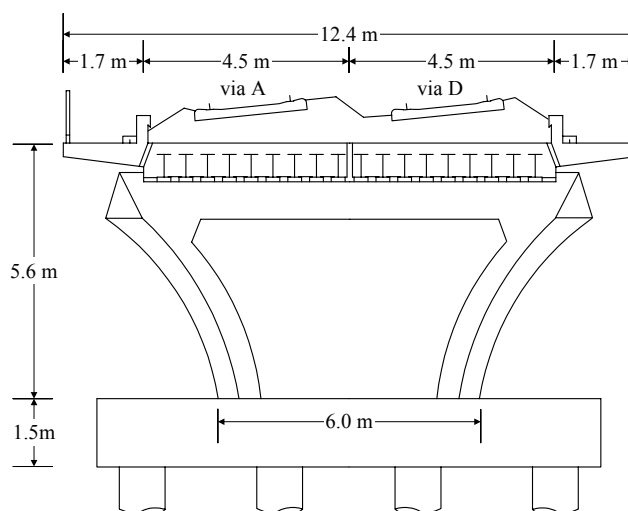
Alçado dum pilar e secção transversal do tabuleiro da ponte de Canelas.
